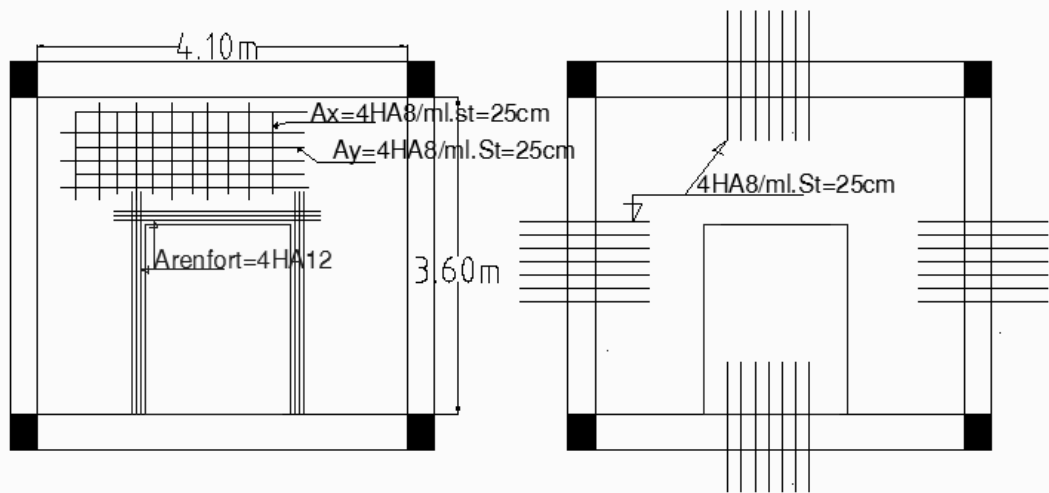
schéma de ferrailage du panneau sur 4 appuis
